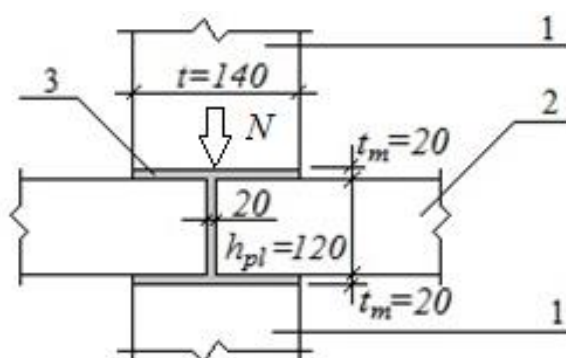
К расчету податливости платформенного стыка: 1 – стеновая панель; 2 – плита перекрытия; 3 – растворный шов
